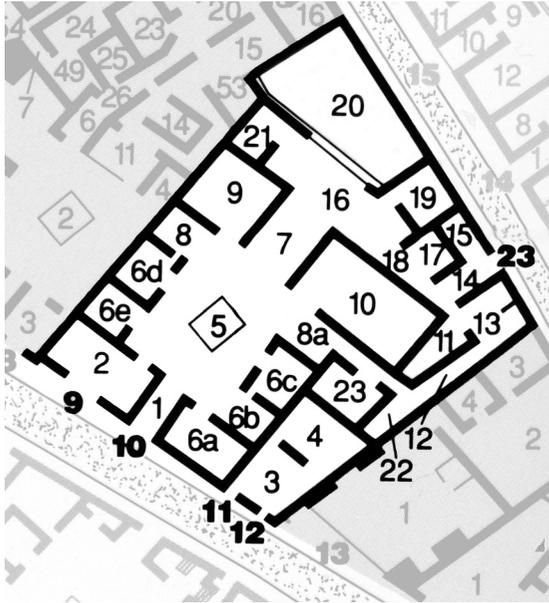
Grundriss der Casa del Chirurgo.
